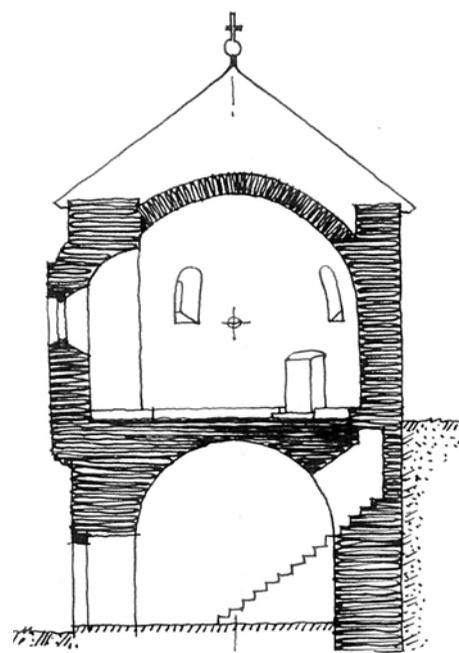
Schnitt/Grundrisse des Karners Hardegg, M 1:200. Planarchiv des Bundesdenkmalamtes Wien.
